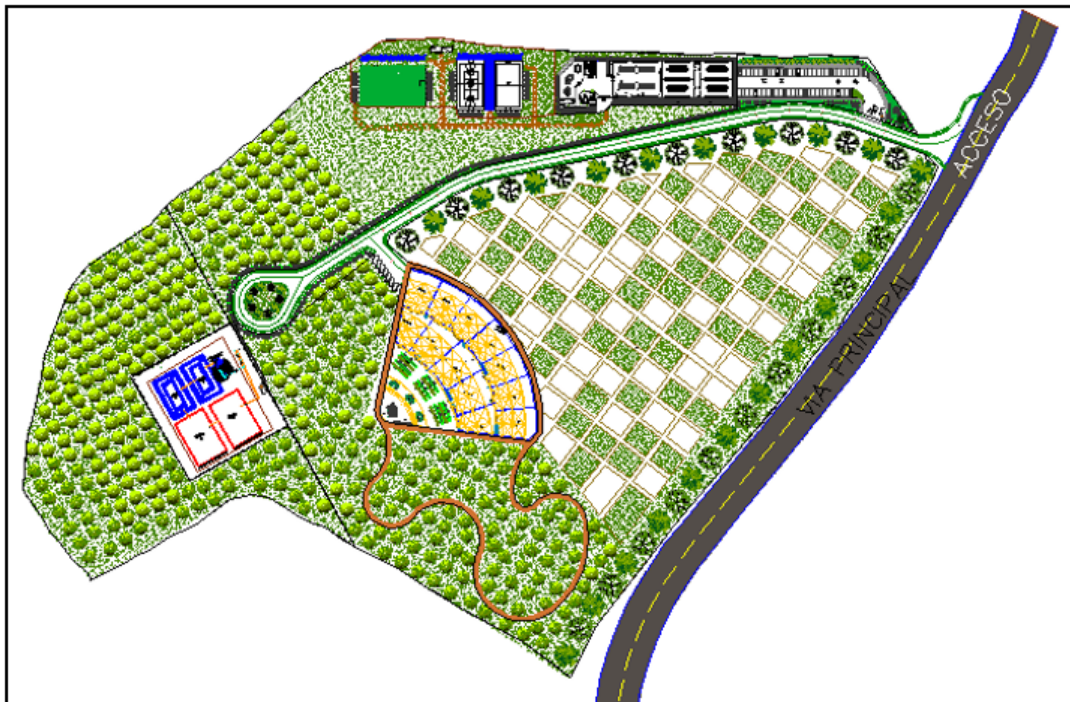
Diseño de propuesta del proyecto (Anexo Plano N°5).
